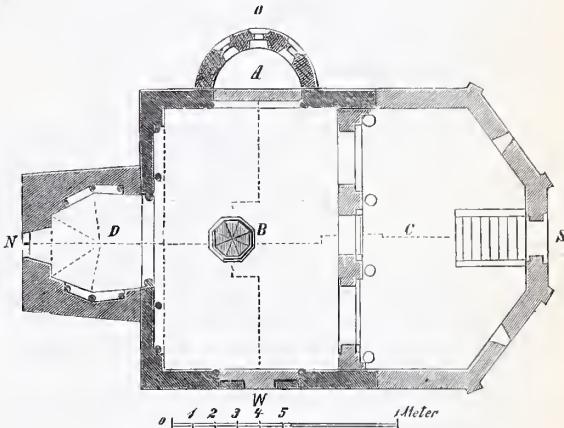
Grundriss von St. Jean in Poitiers.
